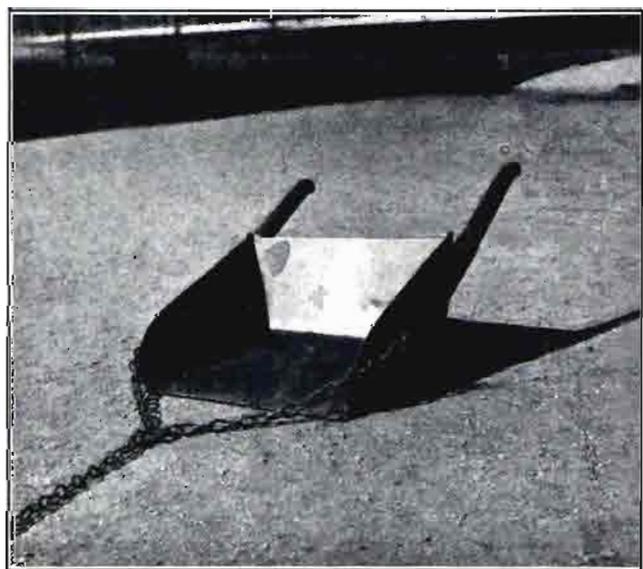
Arrobadera metálica con manceras de madera. Enganche con cadena.
